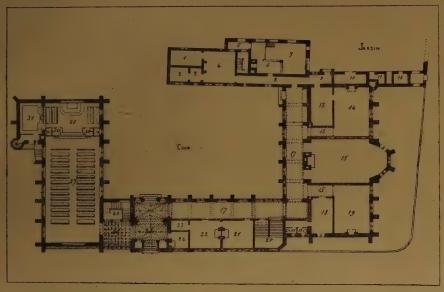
Nouveau Collège de Manchester, à Oxford, plan du rez-de-chaussée.
